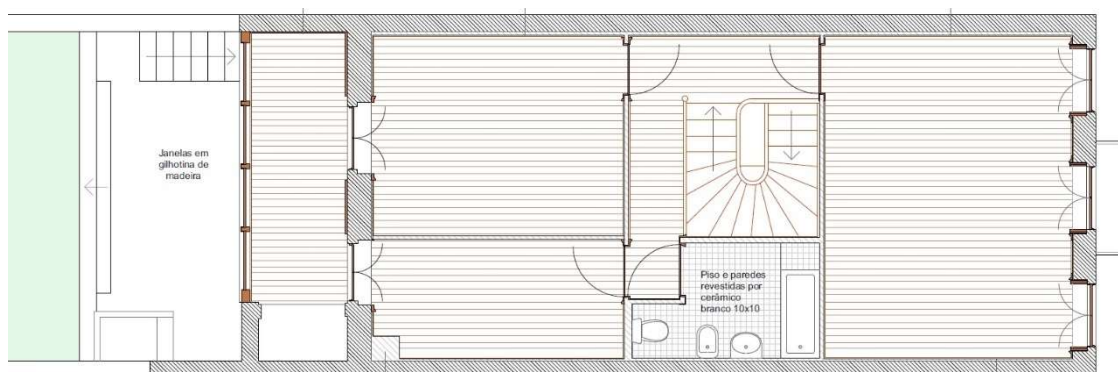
Planta do estado atual do 2º piso, espaços privados da habitação.
